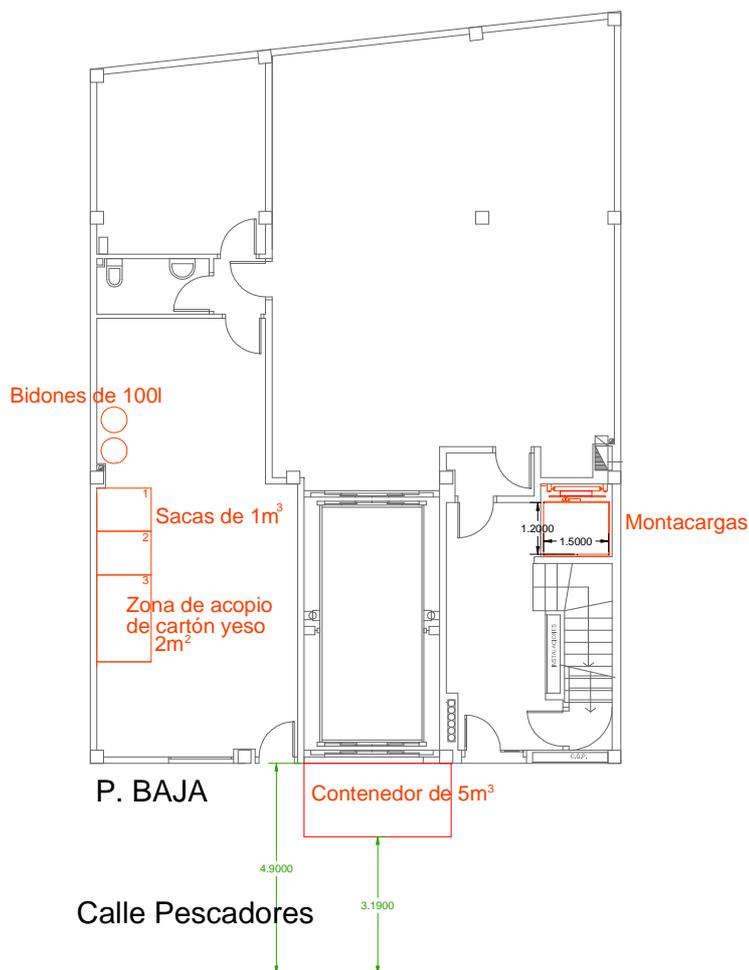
Ubicación en planta de contenedores de recogida de residuos
